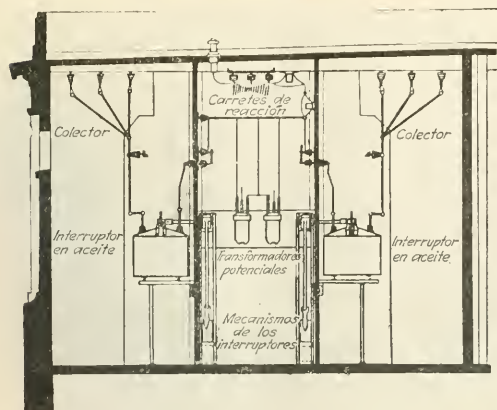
SECCIÓN TRANSVERSAL DEL EXTREMO IZQUIERDO DE LA BATERÍA DE CONMUTADORES
